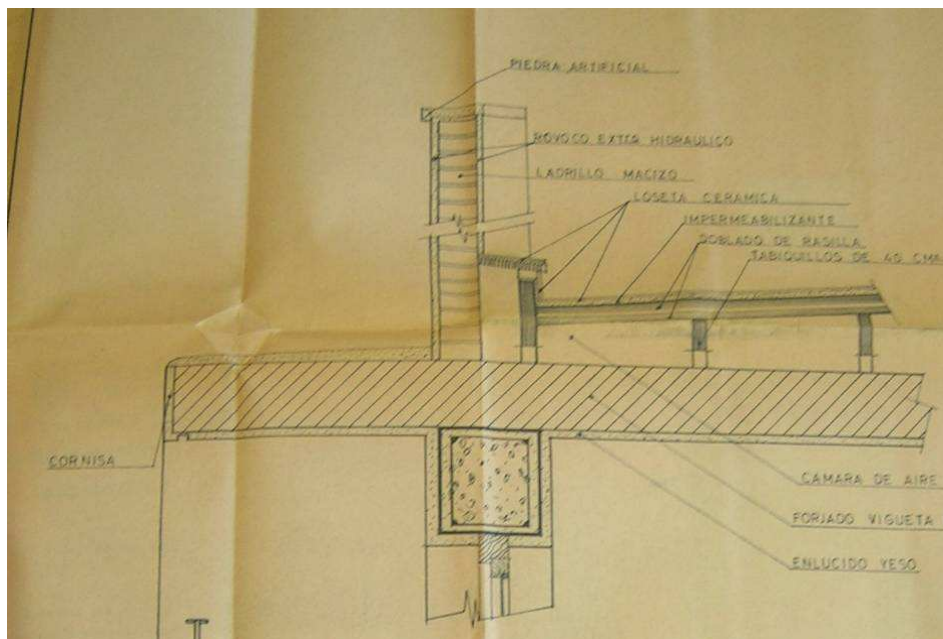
Detalle fachada. Edificio ficha 154A.008, 1964.
